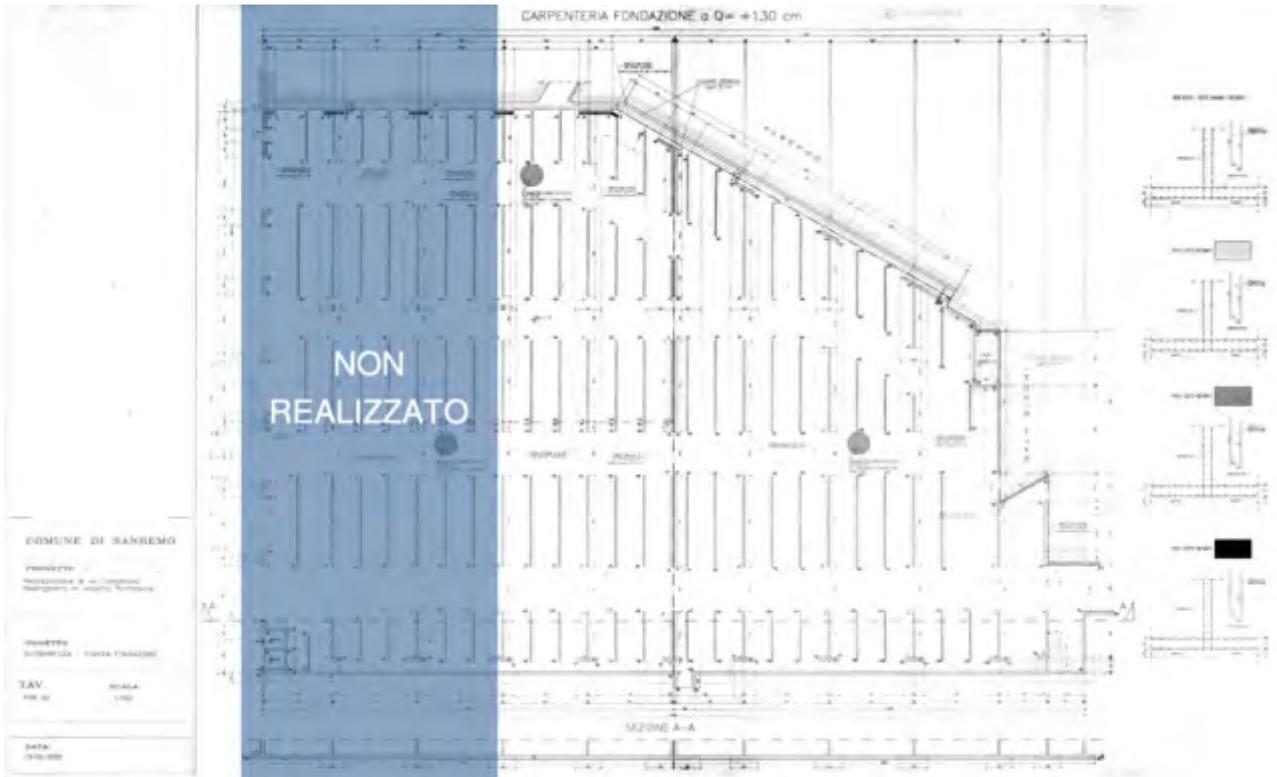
Carpenteria di fondazione (progetto originale delle strutture oggetto di demolizione)
